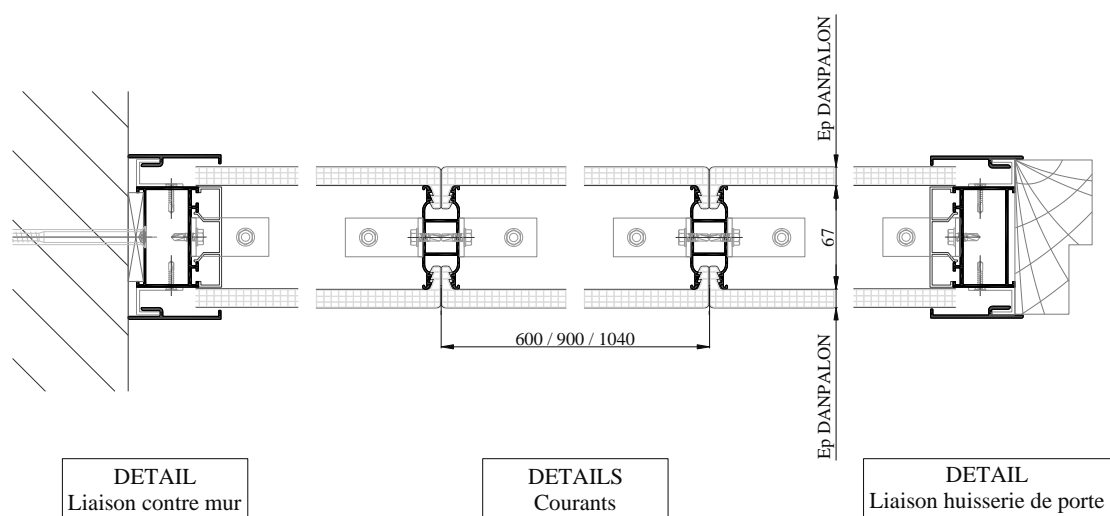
Coupe horizontale – système DANPALON® application cloison double paroi
